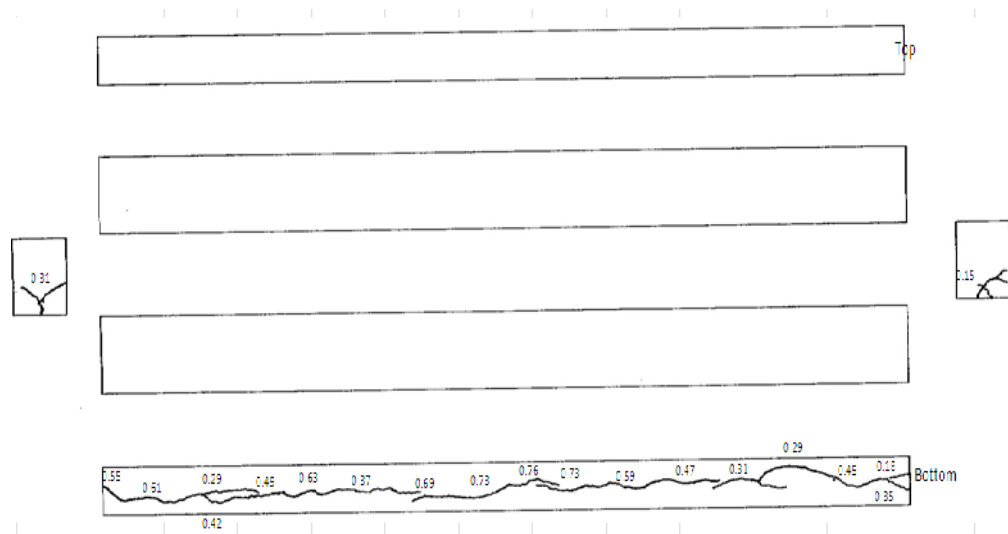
Schéma de fissuration de la poutre (1T16 20 kN) avec les ouvertures des fissures de corrosion en mm.
